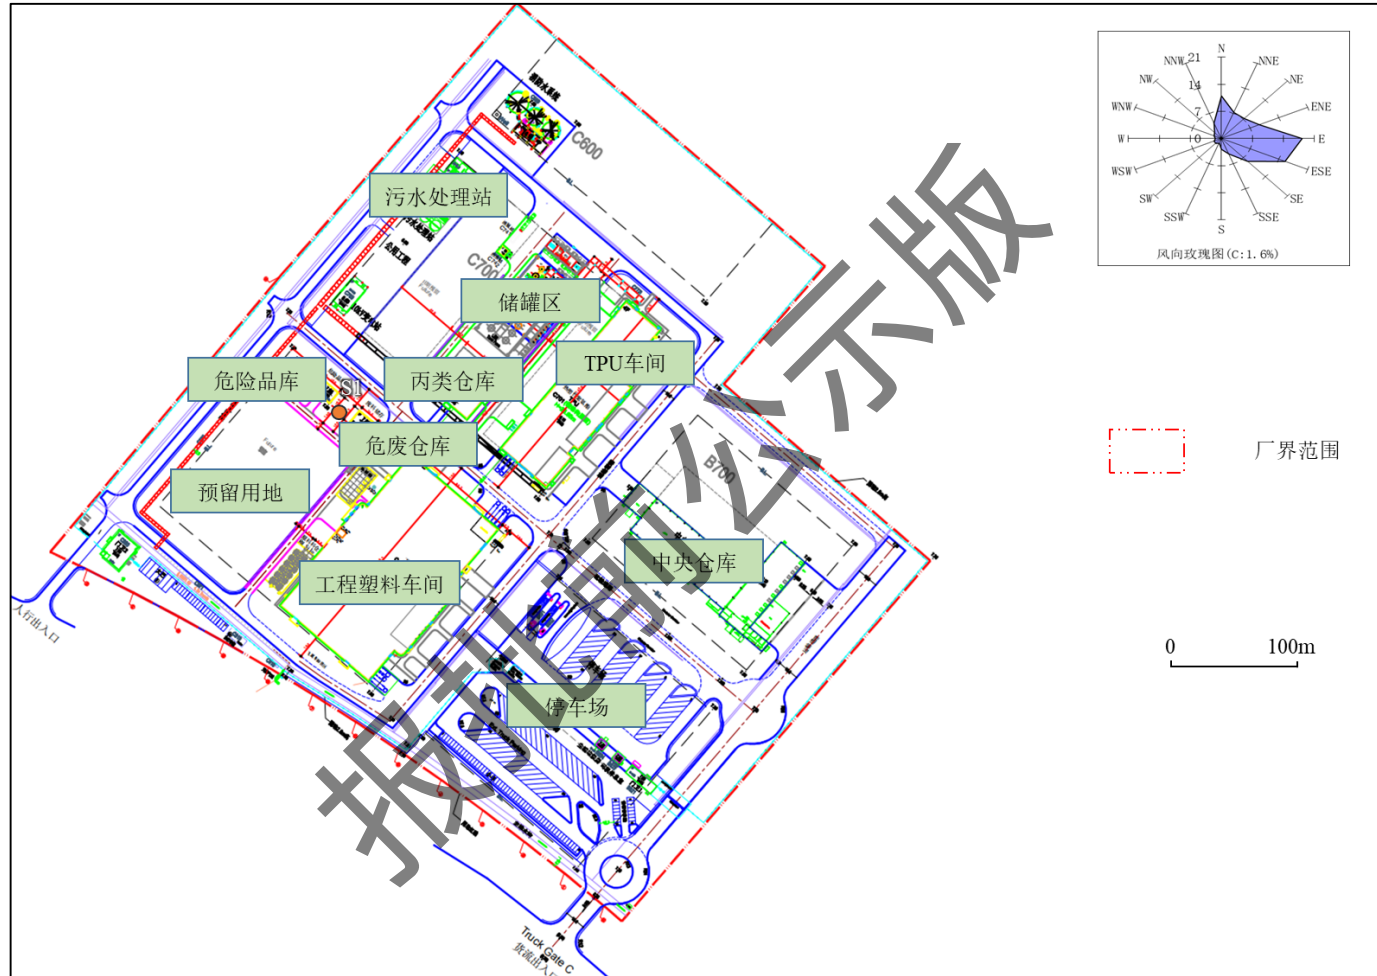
巴斯夫（广东）一体化项目首期总平面图
